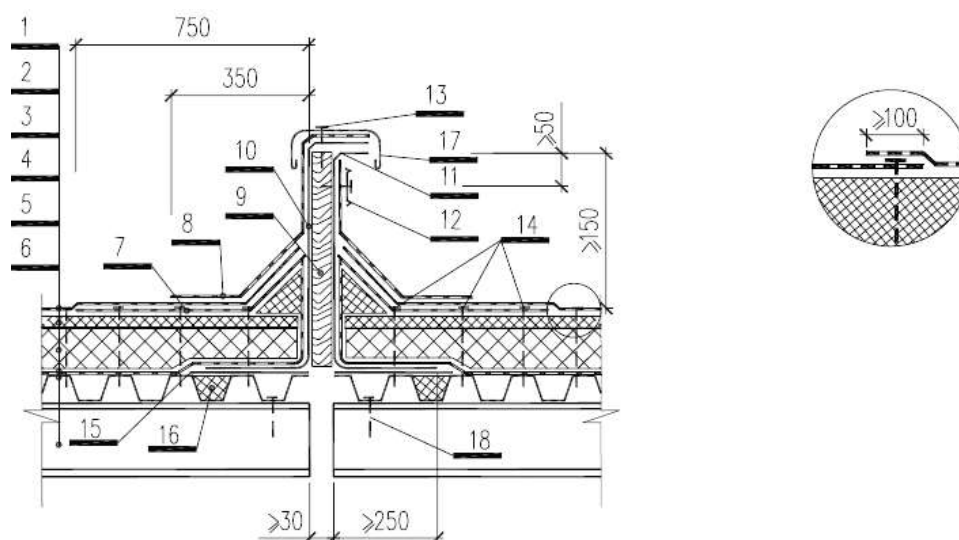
ТДШ кровель со стенками из металлических гнутых профилей при однослойном водоизоляционном ковре: 1 – однослойный водоизоляционный ковёр с механическим креплением; 2 – верхний слой теплоизоляции; 3 – теплоизоляция; 4 – пароизоляция; 5 – профилированный настил; 6 – прогон; 7 – нижний дополнительный слой водоизоляционного ковра; 8 – верхний дополнительный слой водоизоляционного ковра; 9 – мягкий минераловатный утеплитель; 10 – Z-образный гнутый профиль; 11 – [-образный гнутый профиль; 12 – прижимная планка; 13 – саморез; 14 – дюбели крепления водоизоляционного ковра; 15 – дополнительный стальной лист; 16 – плитный негорючий утеплитель; 17 – металлический фартук; 18 – болт самонарезной
